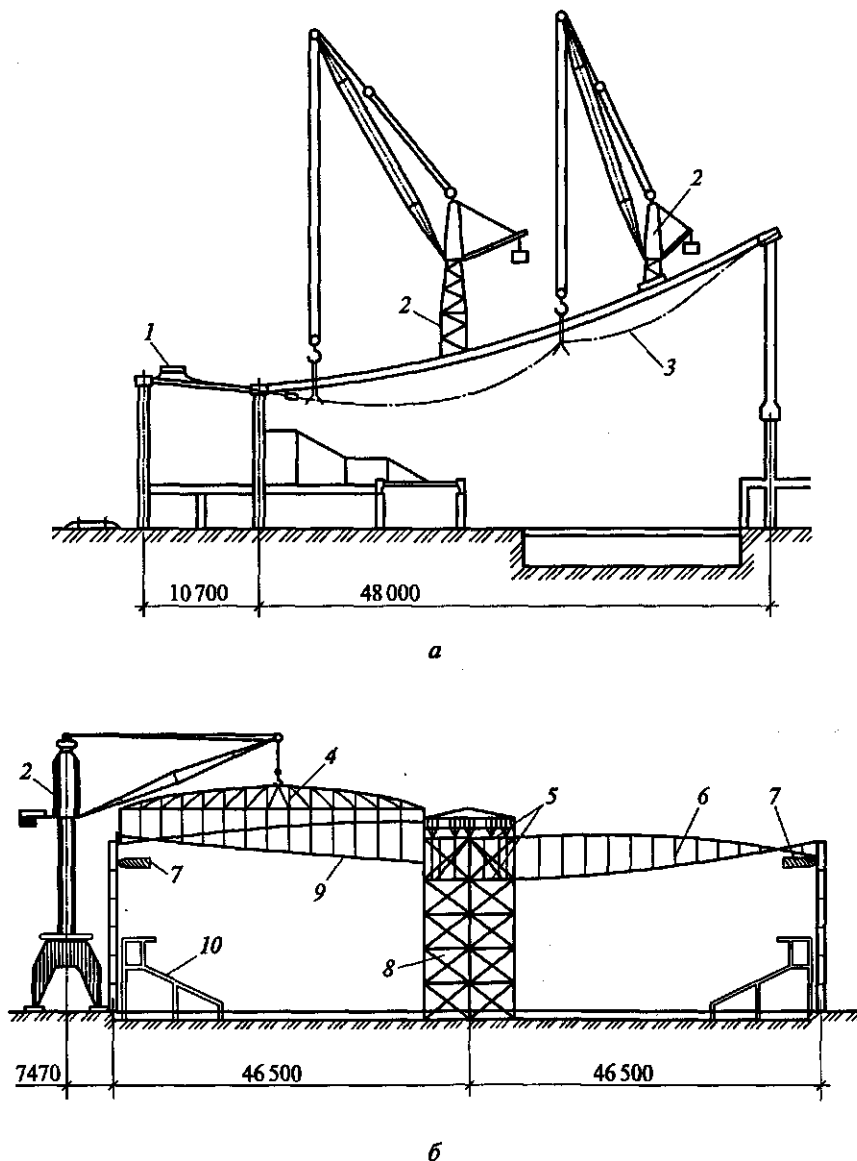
Технологические схемы перекрытия больших пролетов висячими конструкциями:
